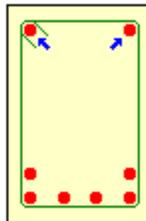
Detalle de las varillas como soporte para armado de estribos.
